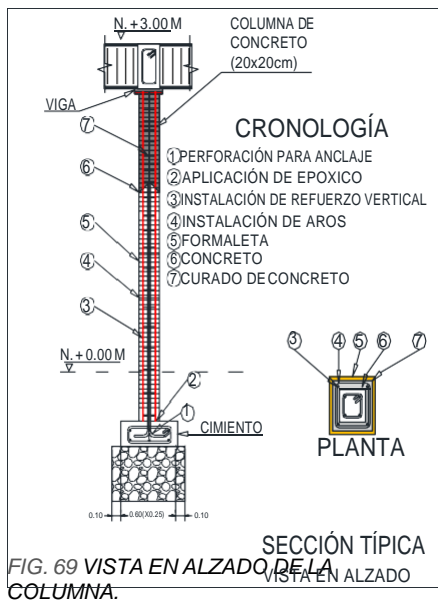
VISTA EN ALZADO DE LA COLUMNA.
